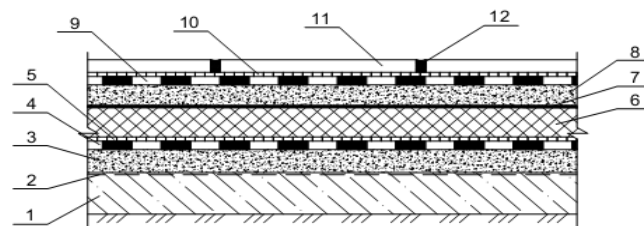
Схема теплоізоляції підлоги в санвузлах:
